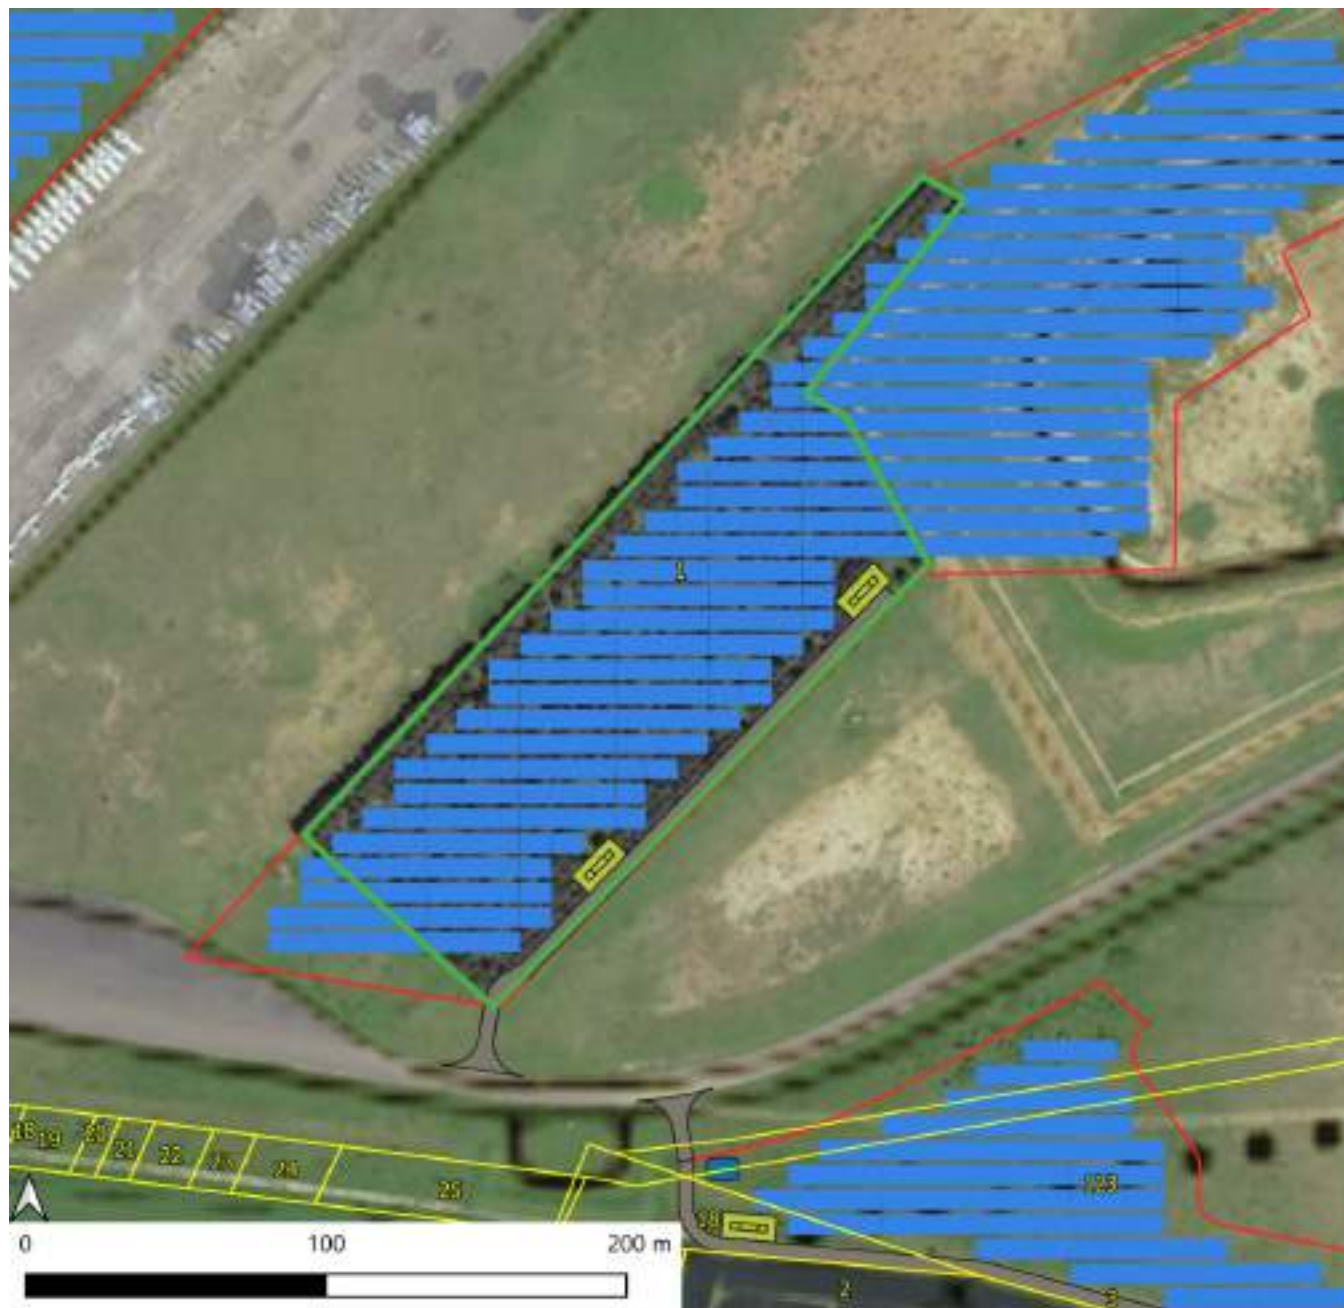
Plan de situation cadastrale – Zoom secteur central
